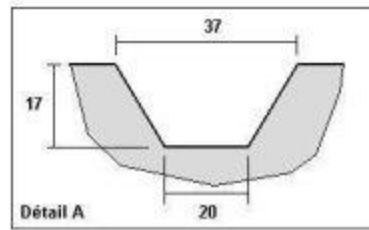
Panneaux à bossage Type 2 (dimensions en mm)
